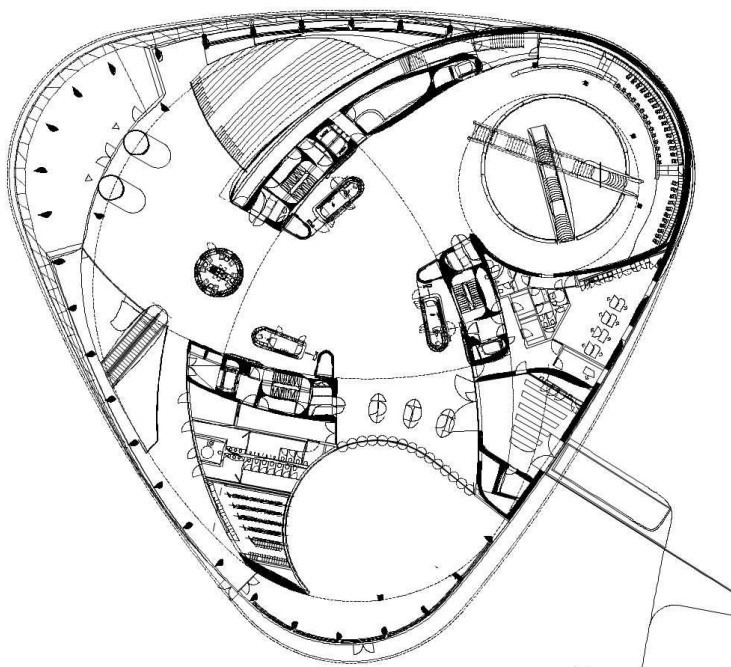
Planta Baixa | Pavimento Térreo Museu Mercedes-Benz. (FONTE: GREGORY, 2009).
